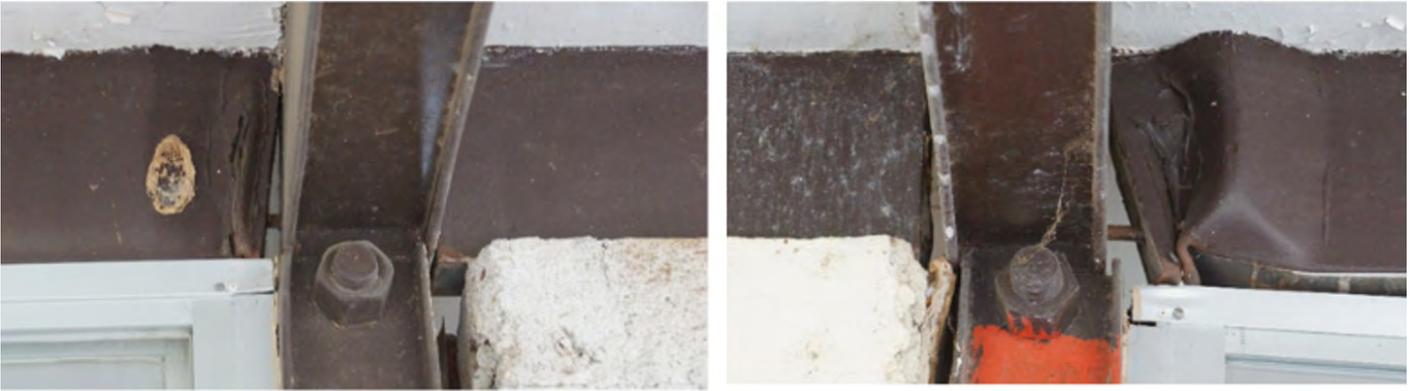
Falla de la soldadura de conexión de la viga con la columna y pandeo local del perfil de acero.
